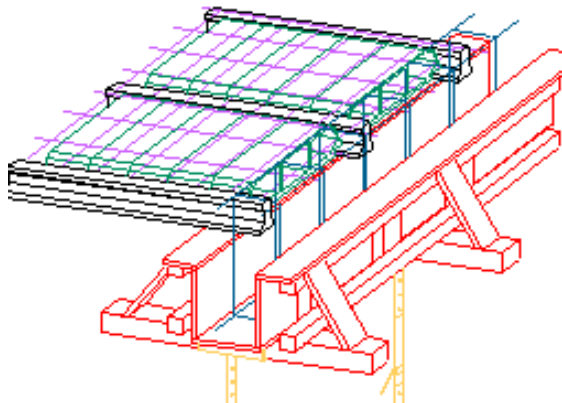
Detalle del apoyo de la vigueta sobre las vigas principales.
